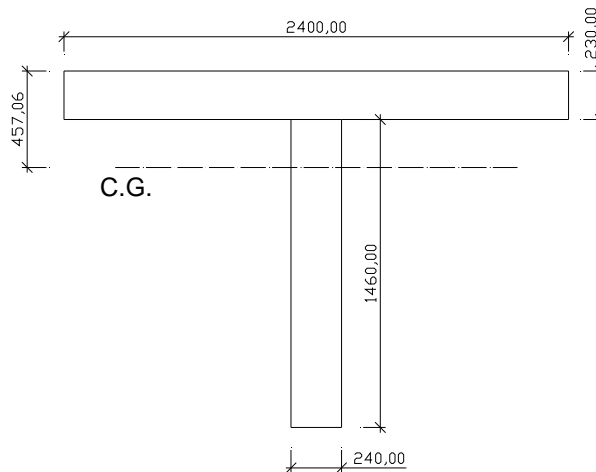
Ubicación del Centro de gravedad de la sección transversal de la viga
